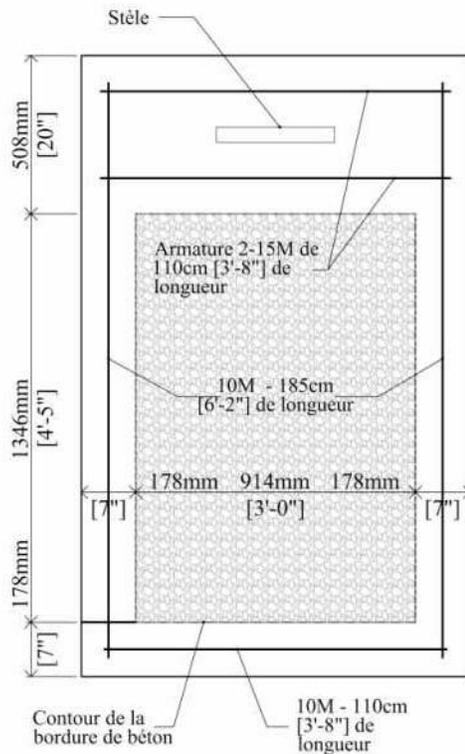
(iv) : Plan de la bordure en béton indiquant la position des armatures. [C. Chandler, DCP, 2004]
